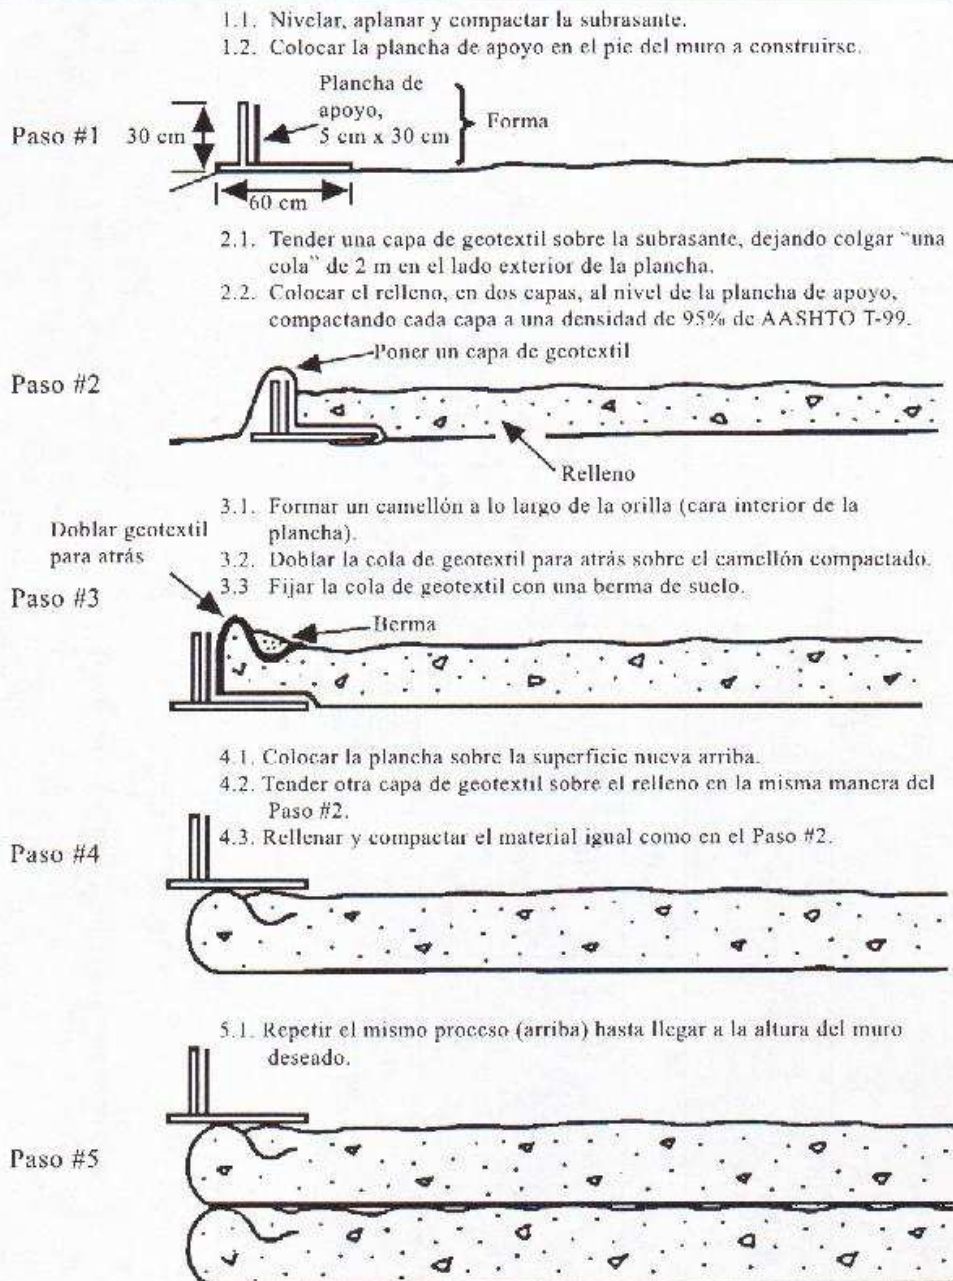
Sección transversal de construcción de un muro de suelo reforzado con geotextil.
